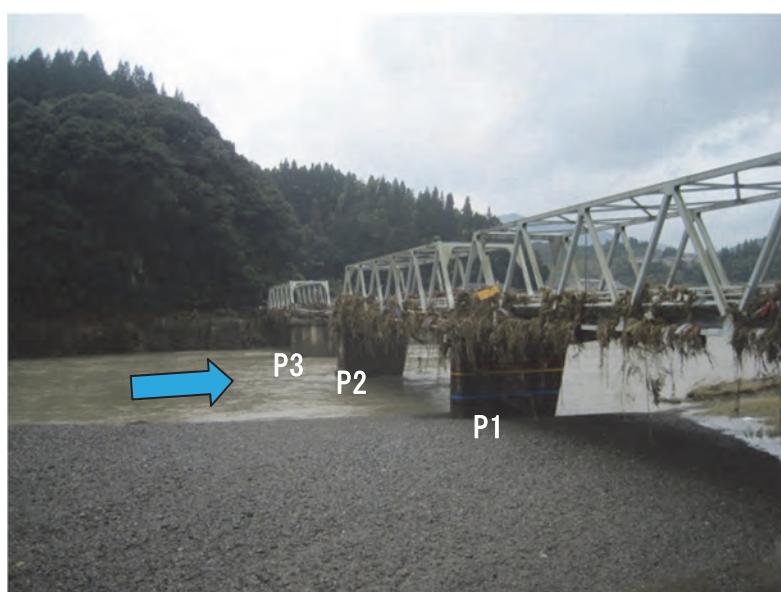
西瀬橋全景 (A1 橋台上流側から)
